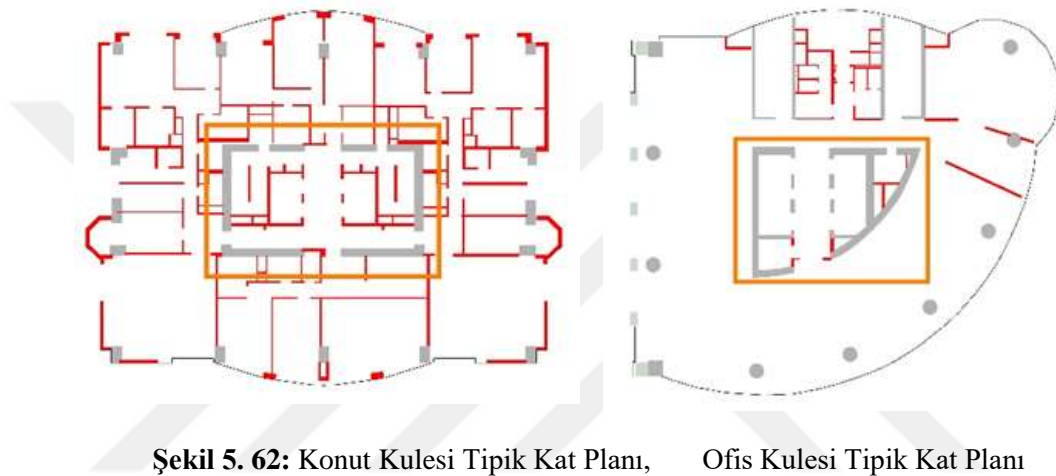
61: Konut Kulesi Tipik Kat Planı, Ofis Kulesi Tipik Kat Planı
